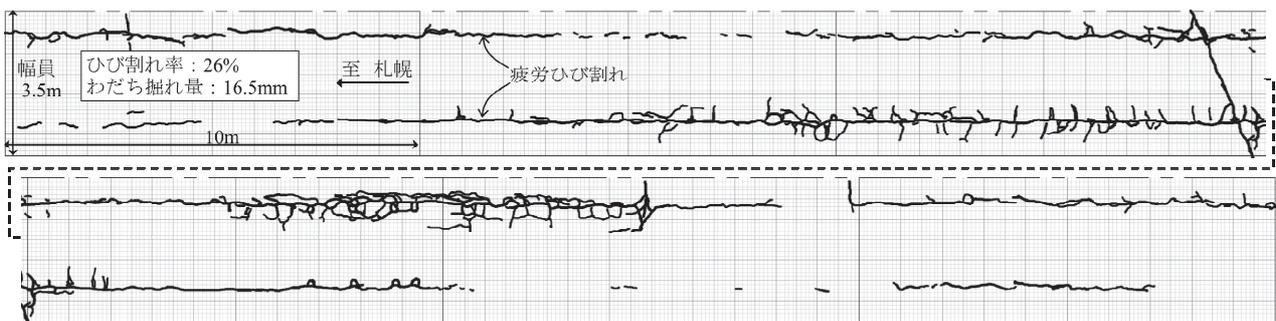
補修前の路面の疲労ひび割れ状況(幅員3.5m、延長60m区間)
